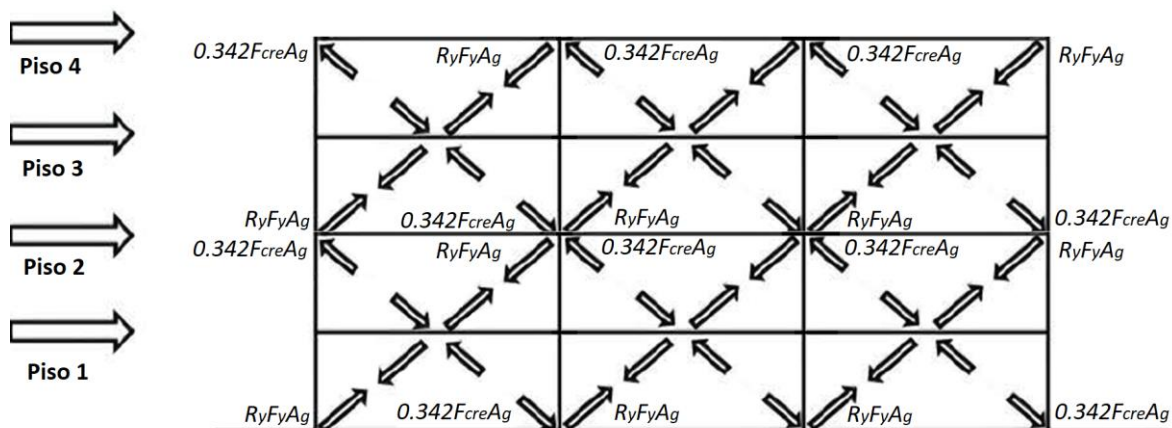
Distribución de las fuerzas de las riostras a vigas y columnas para la Condición 2
